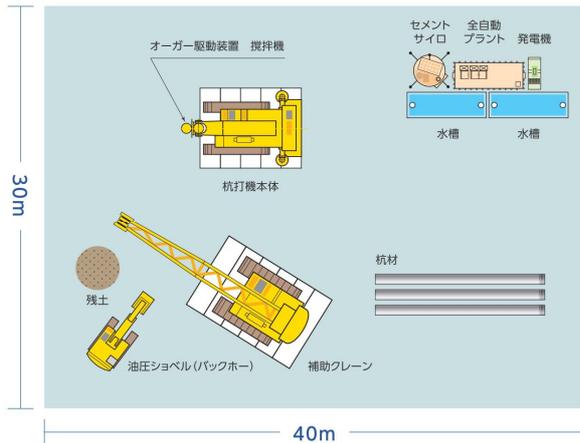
14 基礎工打設の重機配置イメージ⁴⁾
